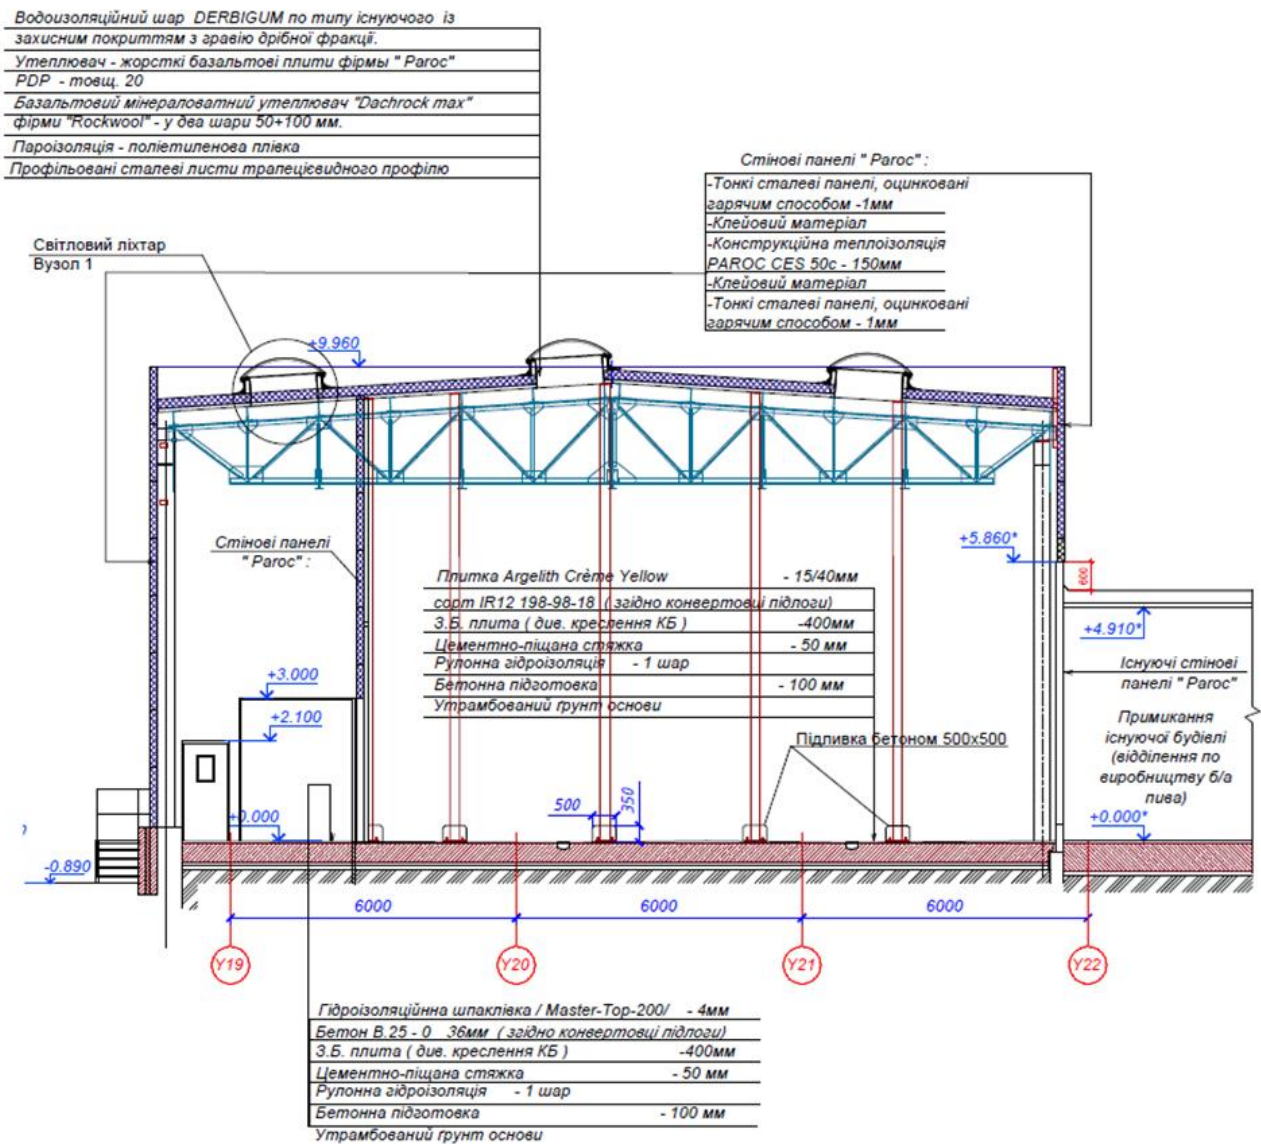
Розріз будівлі в осях Y19-Y22
